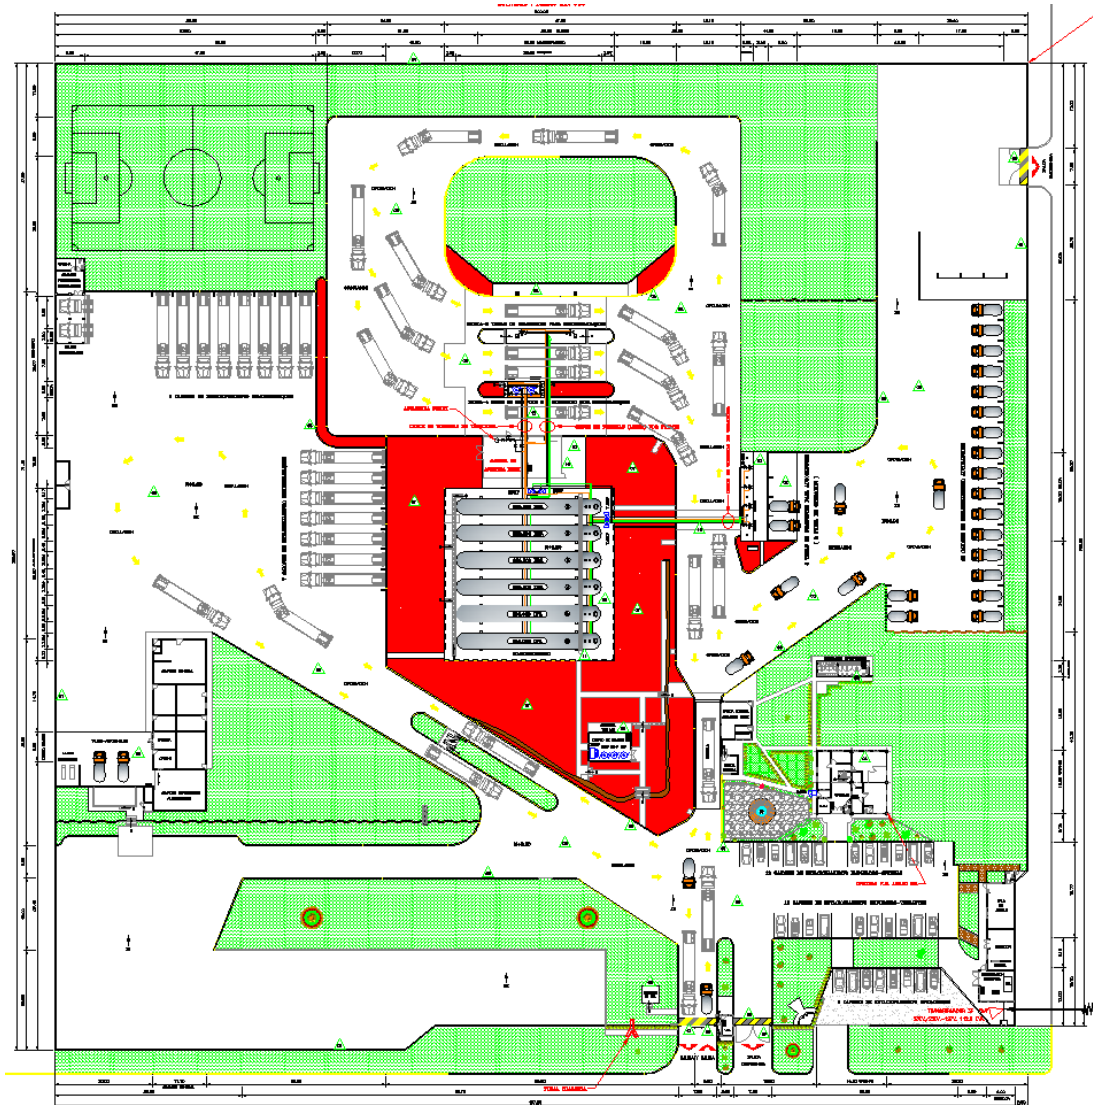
Plano general de la Planta de Distribución de Gas L.P.
